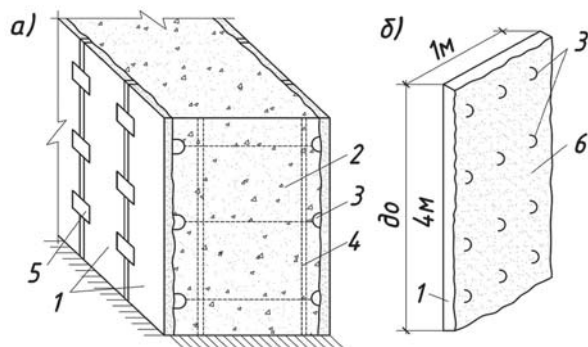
Огорожувальна стінова монолітна конструкція з незнімною опалубкою із тонкостінних залізобетонних елементів:
